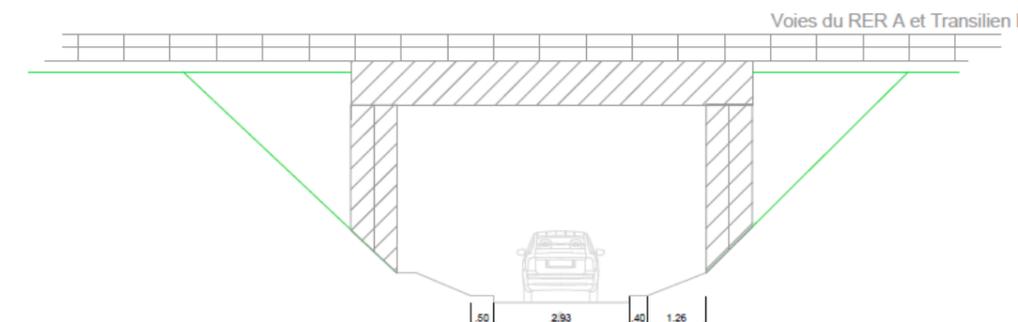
Coupe type du nouveau pont-rail Route du Clocher
